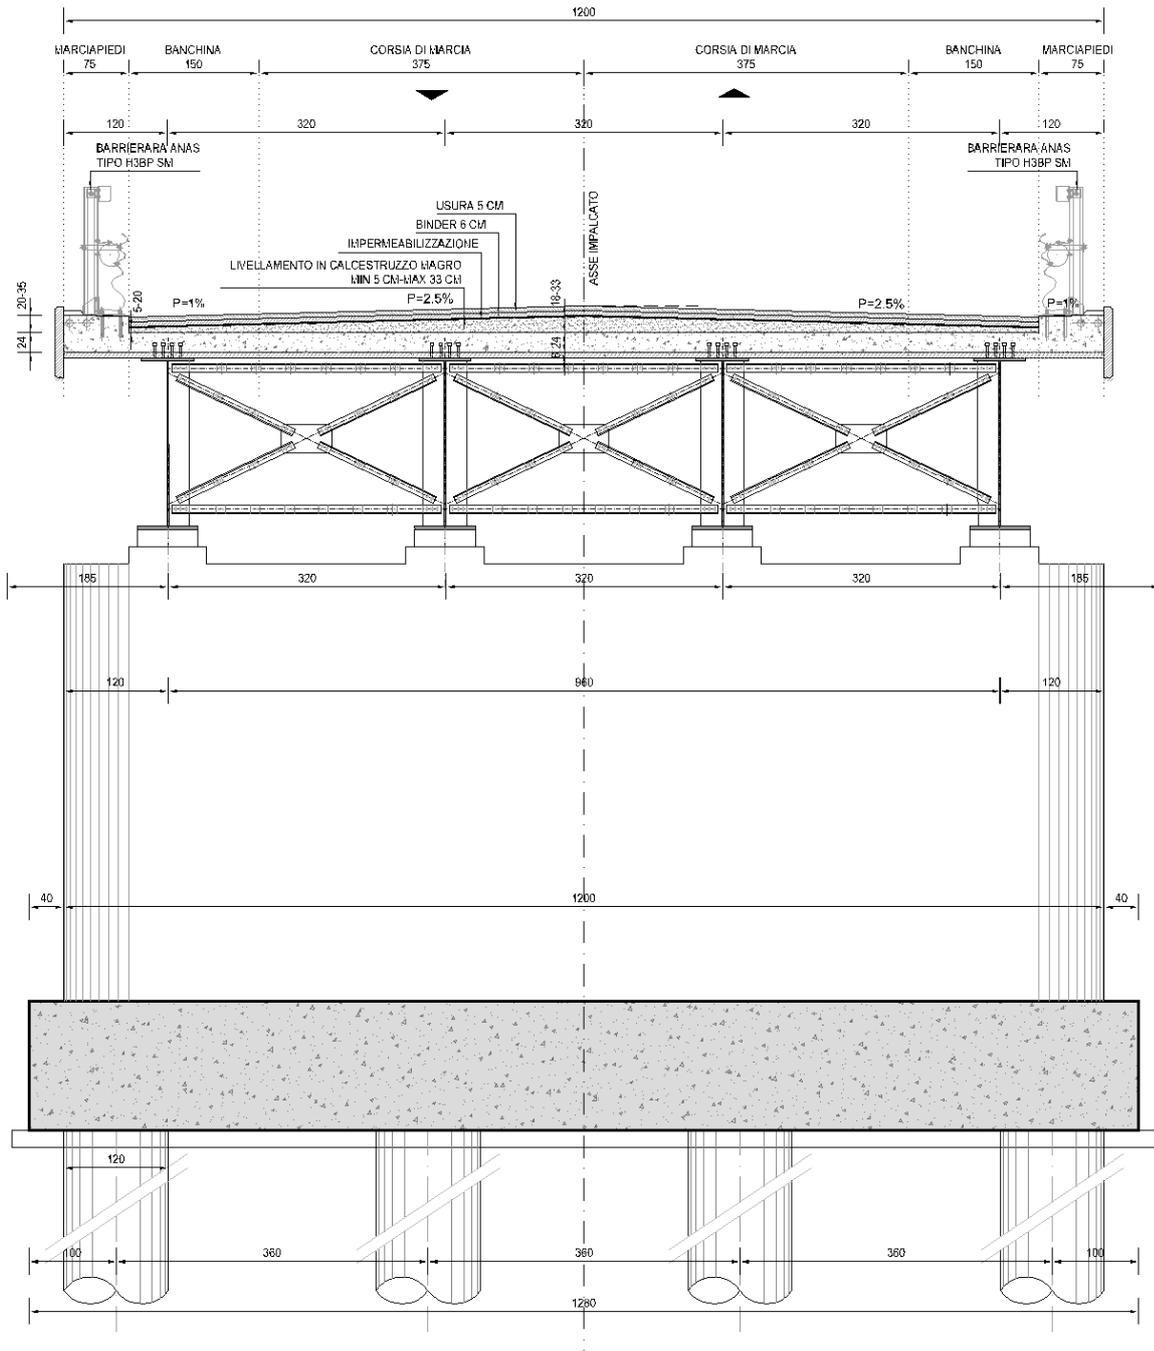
SEZIONE IMPALCATO (SU PILA)
